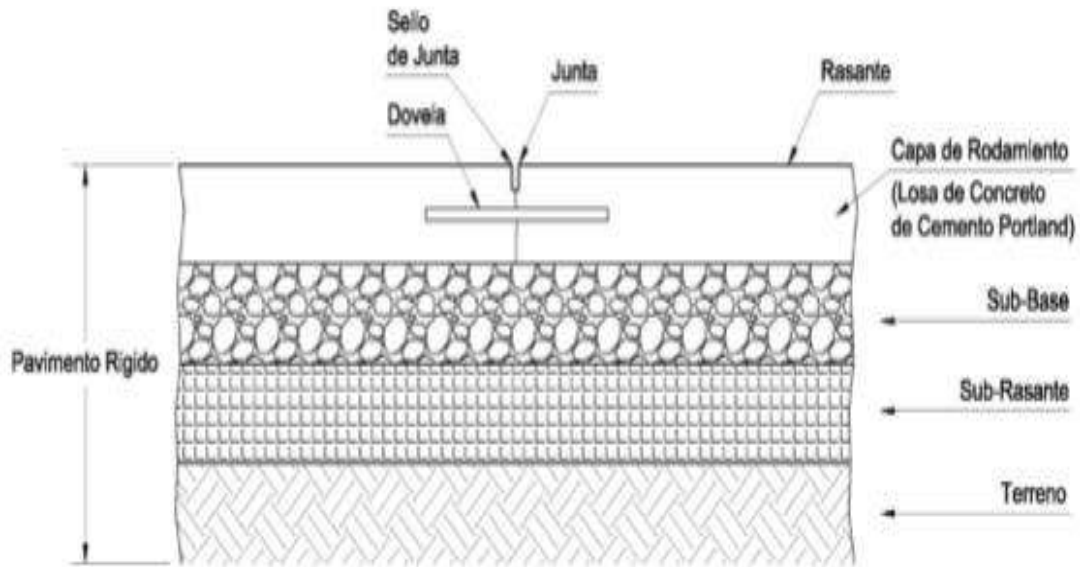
Esquema básico de la estructura de un pavimento rígido.
